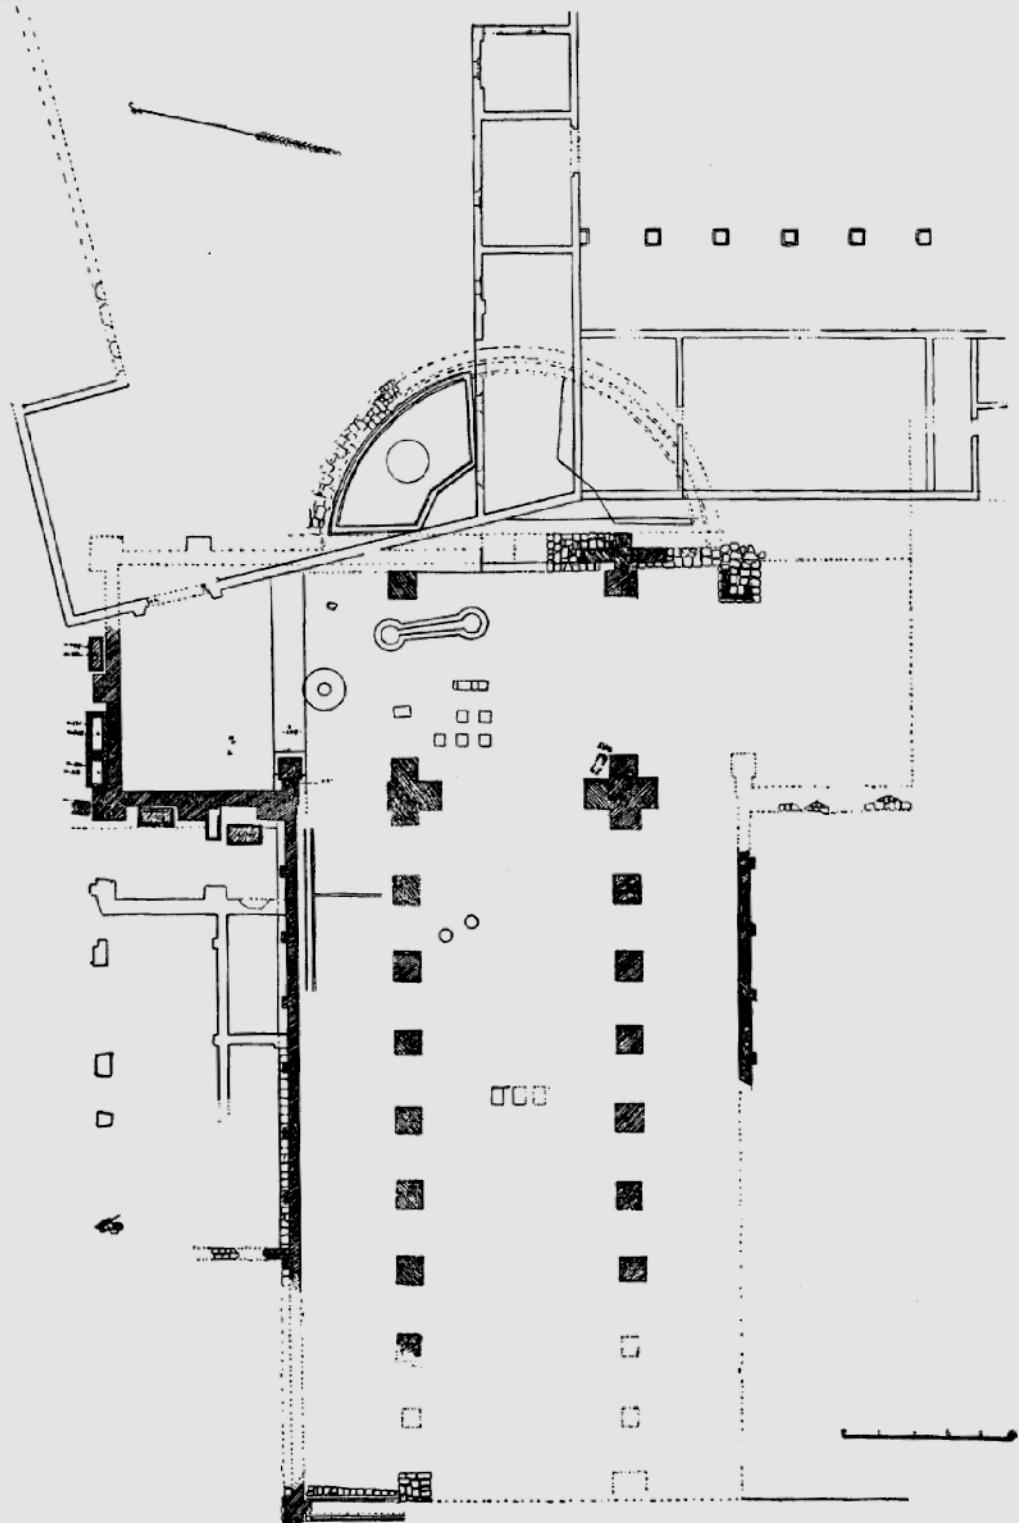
Pianta della basilica del fondo Tullio (da BRUSIN, ZOVATTO 1957).
